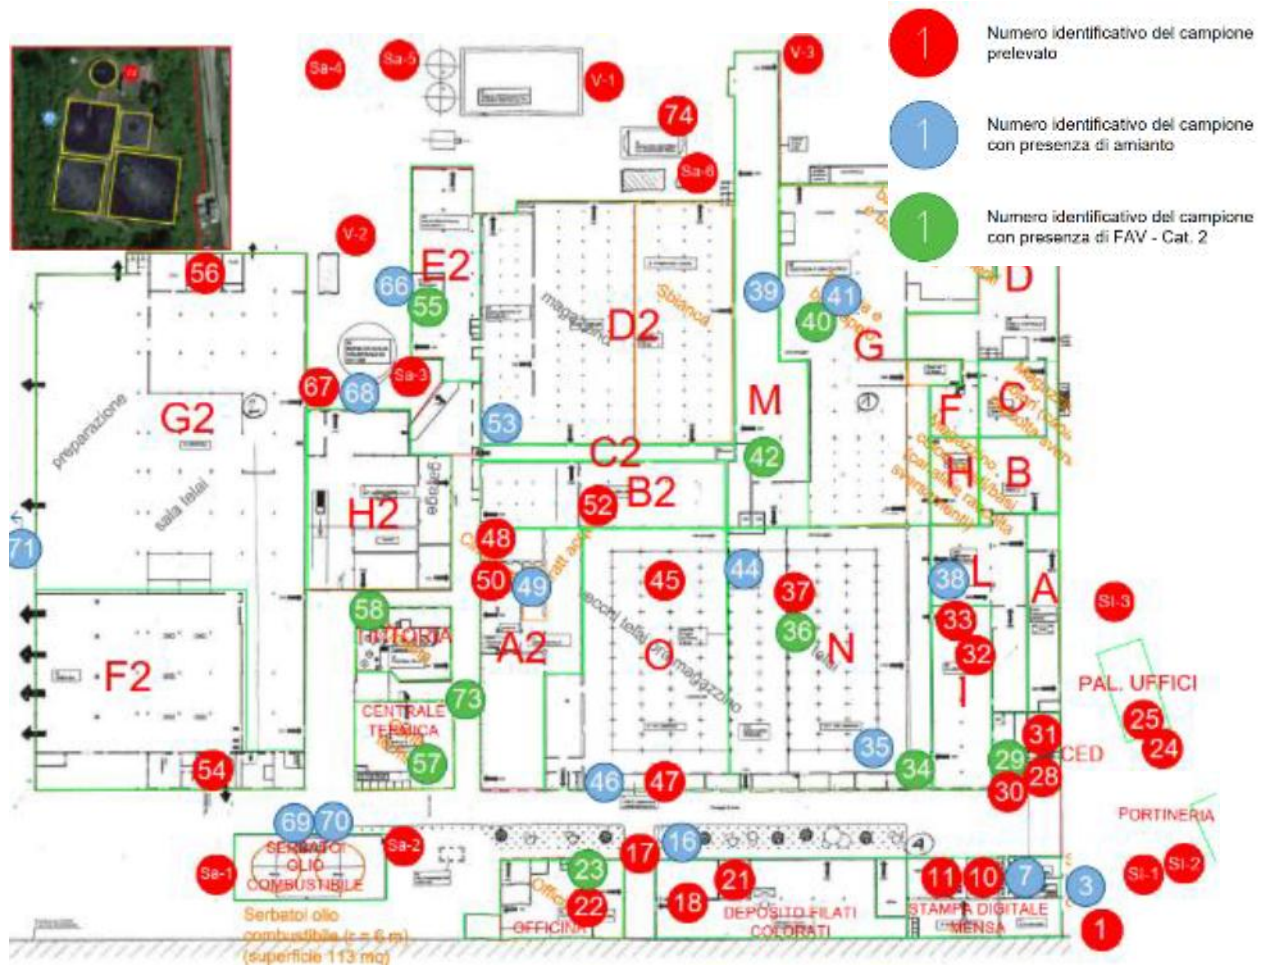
Stralcio planimetrico (APPENDIX F) con individuazione dei punti di campionamento del materiale di tipo MCA (in blu) e FAV (in verde).
